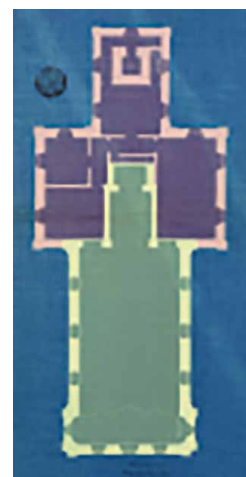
Planta da Igreja dos Anjos. Espaço da nave da antiga igreja (amarelo) sobre a planta do projeto da nova igreja (outras dependências a roxo). 2017, Ana Gil.
